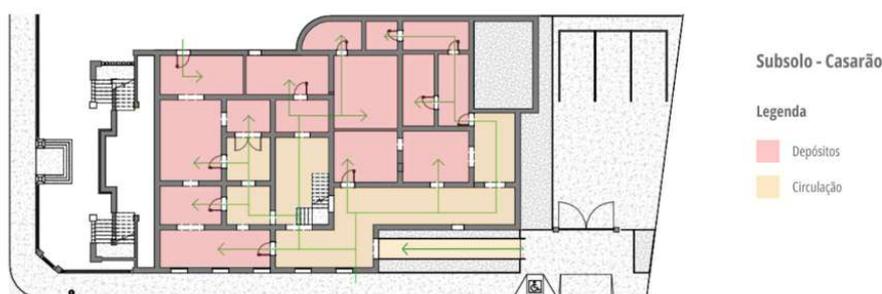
Planta Baixa Subsolo Casarão com setorização
